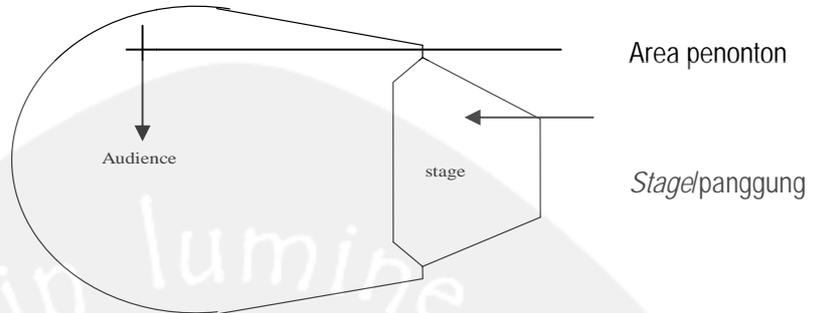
Denah Gedung Pertunjukan dengan bentuk kipas
